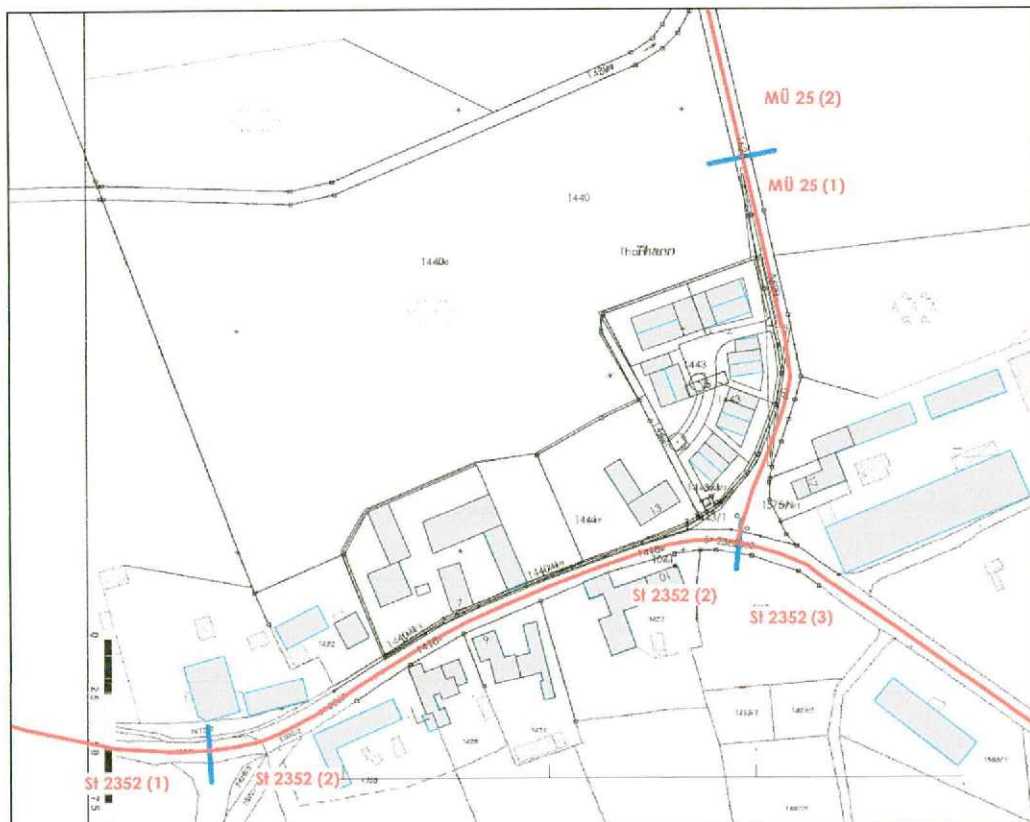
Lageplan mit Eintragung der relevanten Straßenabschnitte
